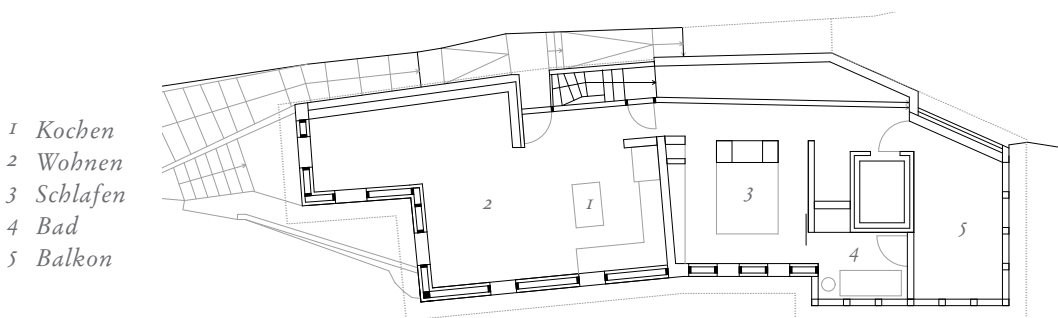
Grundriss Wohnhaus DR. R. & DR. P.
